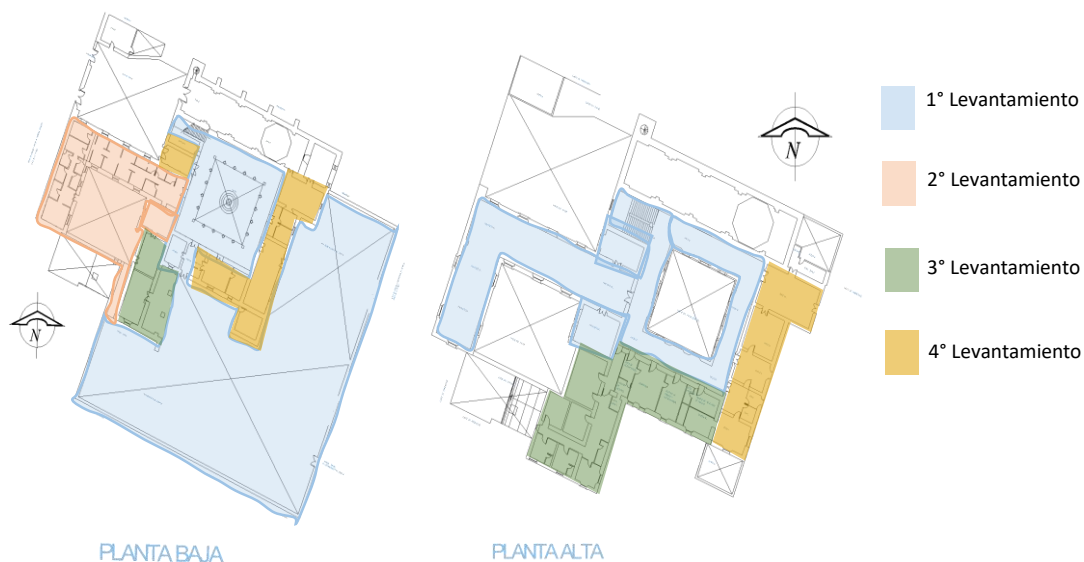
Plano donde se marcan los espacios en los que se realizó levantamiento en planta baja y planta alta.
